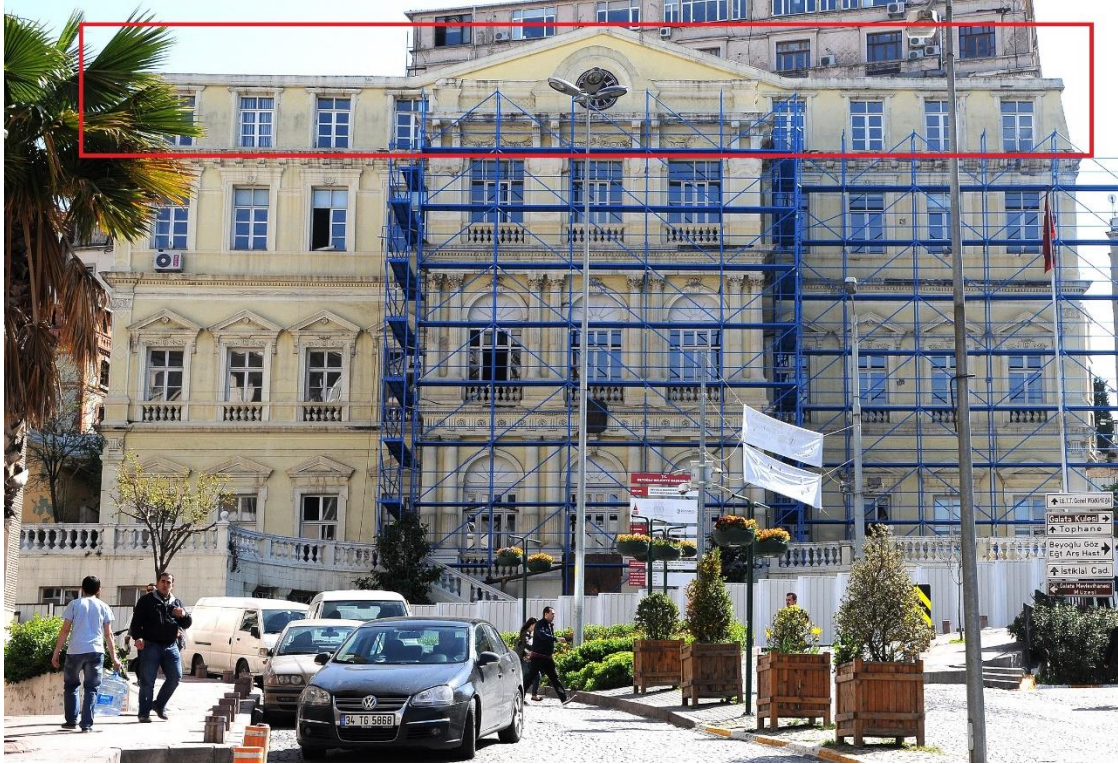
Çatı katının çelik konstrüksiyon ile değişmeden önceki betonarme ekleme hali (Beyoğlu Belediyesi Arşivi)
